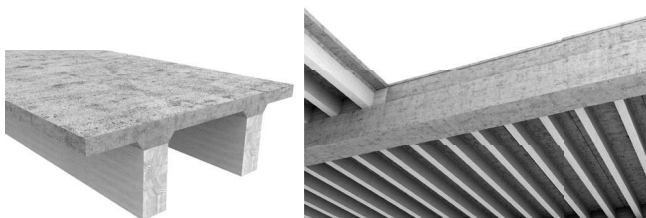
Infografía del producto prefabricado MCLamBS mixto formado por vigas laminadas de chopo o mixtas chopo-pino y la losa de hormigón y su aplicación. Fuente: PEMADE-Universidad de Santiago de Compostela. <https://life-woodforfuture.eu/>
